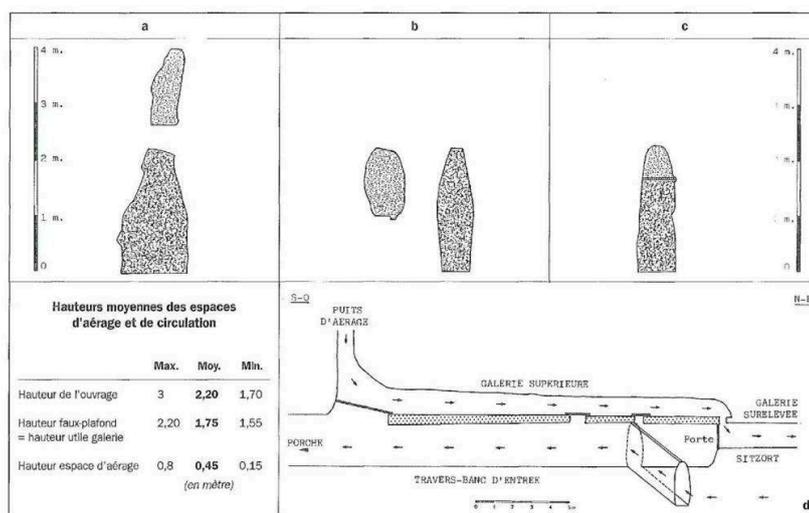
Nature des ouvrages supérieurs de canalisation d'air dans la mine de la Fontaine des Chouettes. – a : galerie supérieure ; – b : galerie surélevée ; – c : faux-plafond ; – d : coupe des ouvrages dans un plan nord-est/sud-ouest. Les flèches correspondent à la circulation de l'air en été.
